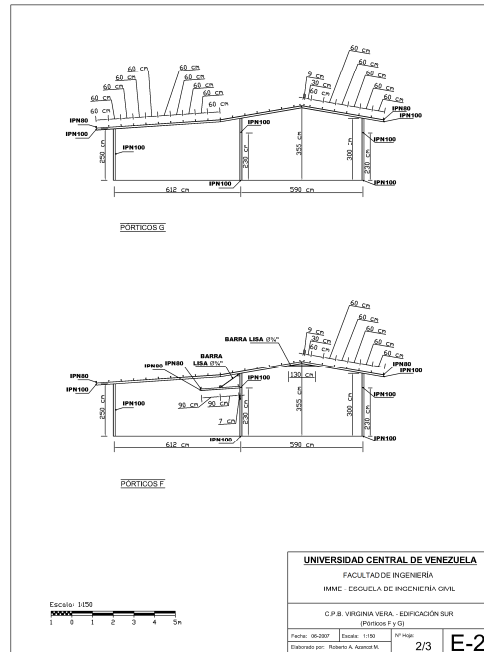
Plano E2: Plano Estructural de los pórticos F y G
